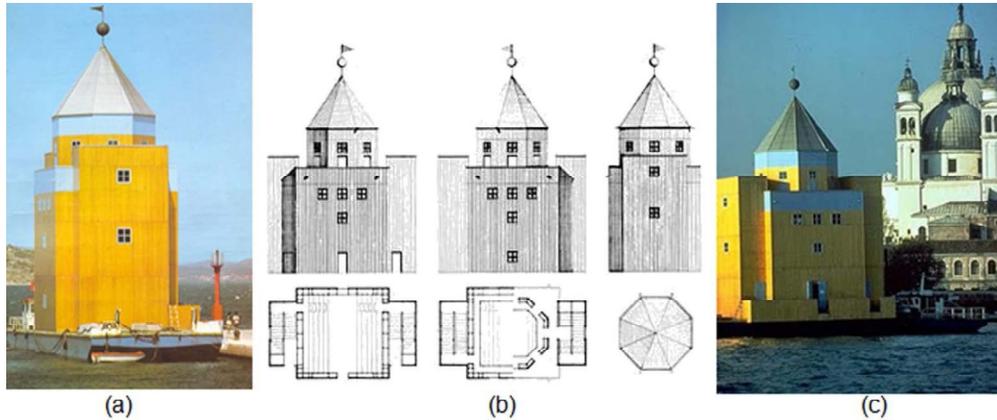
Aldo Rossi, Teatro del Mundo, Venecia, (1979): (a) Vista exterior lateral, (b) Alzados y plantas arquitectónicas, (c) Vista exterior frontal.
